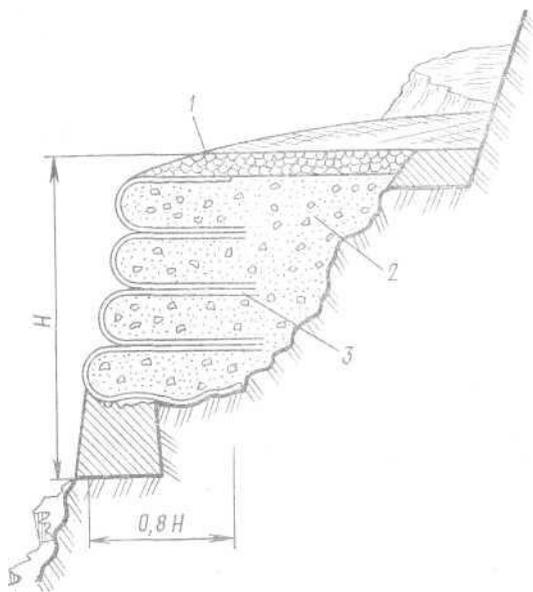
Восстановление земляного полотна устройством армированной насыпи: 1 — покрытие из каменного материала; 2 — скальный грунт; 3 — арматура из ткани (металлической сетки).
